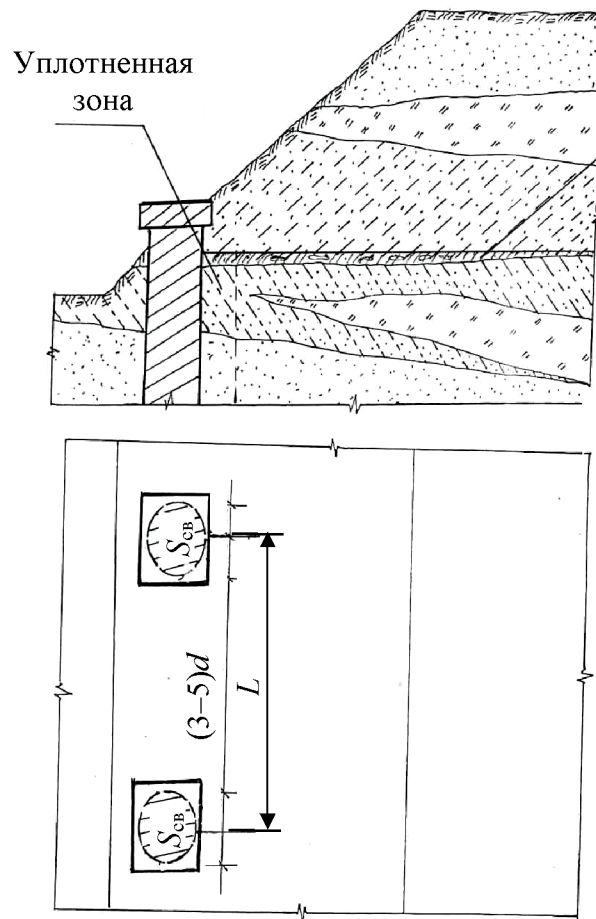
Схема расположения буронабивных свай: $S_{св}$ – поперечное сечение свай; L – расстояние между сваями
